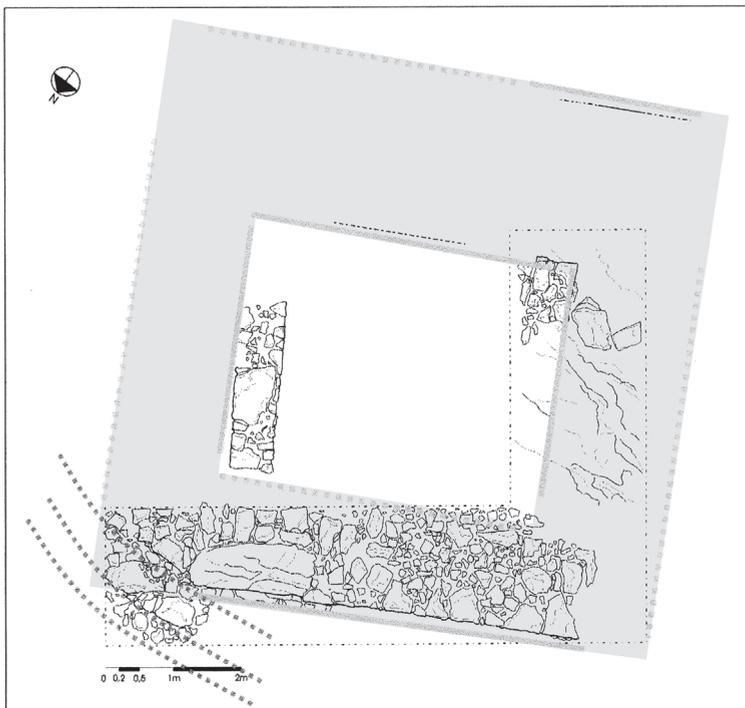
Planta dos vestígios do farol da Berlenga (apud Jacinta Bugalhão e Sandra Lourenço).
